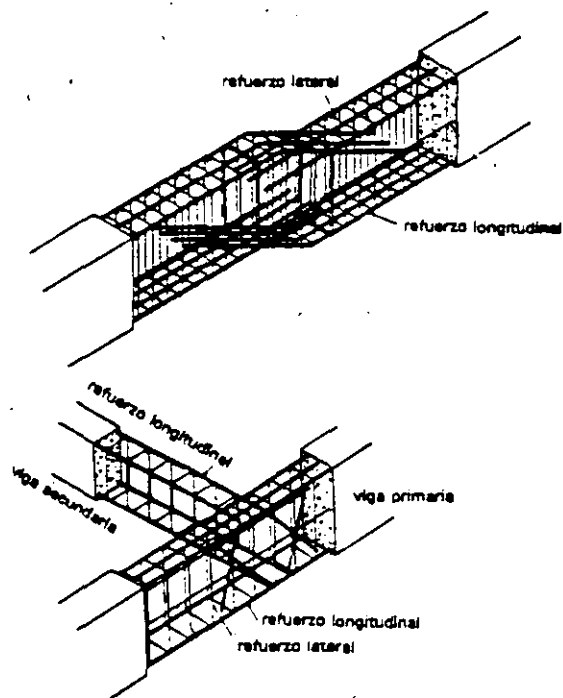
Detalle de refuerzo en viga con desnivel y del apoyo de una viga secundaria en una primaria
